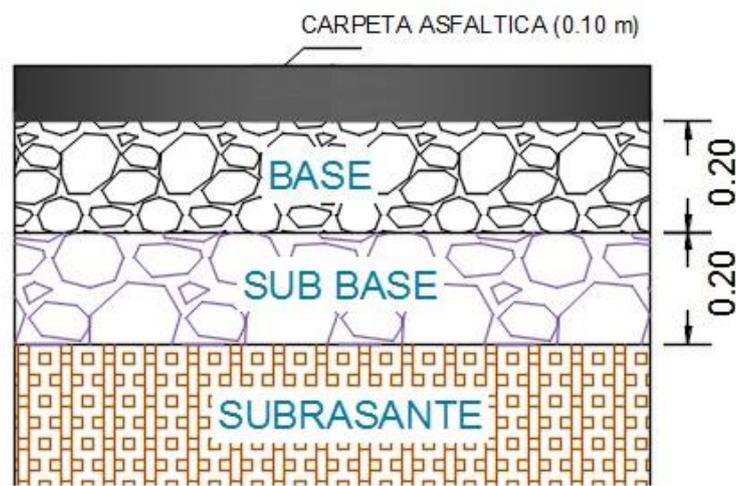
Estructura del Pavimento (Fuente: Elaboración Propia, datos de campo)
